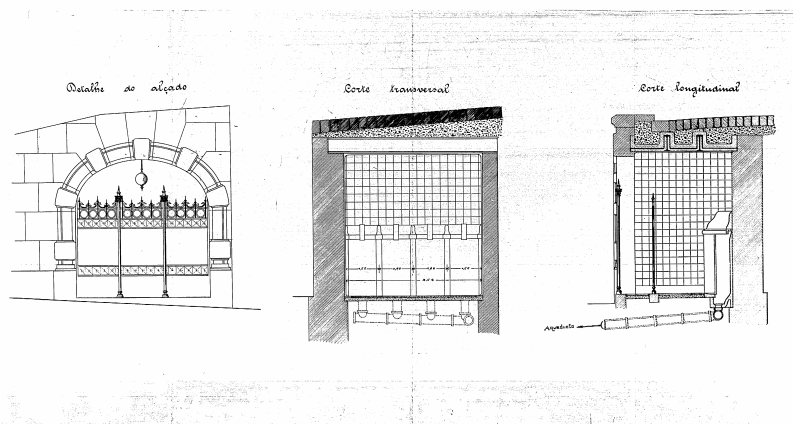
Projecto de um mictório a construir n'esta rua sob o pavimento da rua do Souto (A.H.M.P D-CMP-02-045-003)
